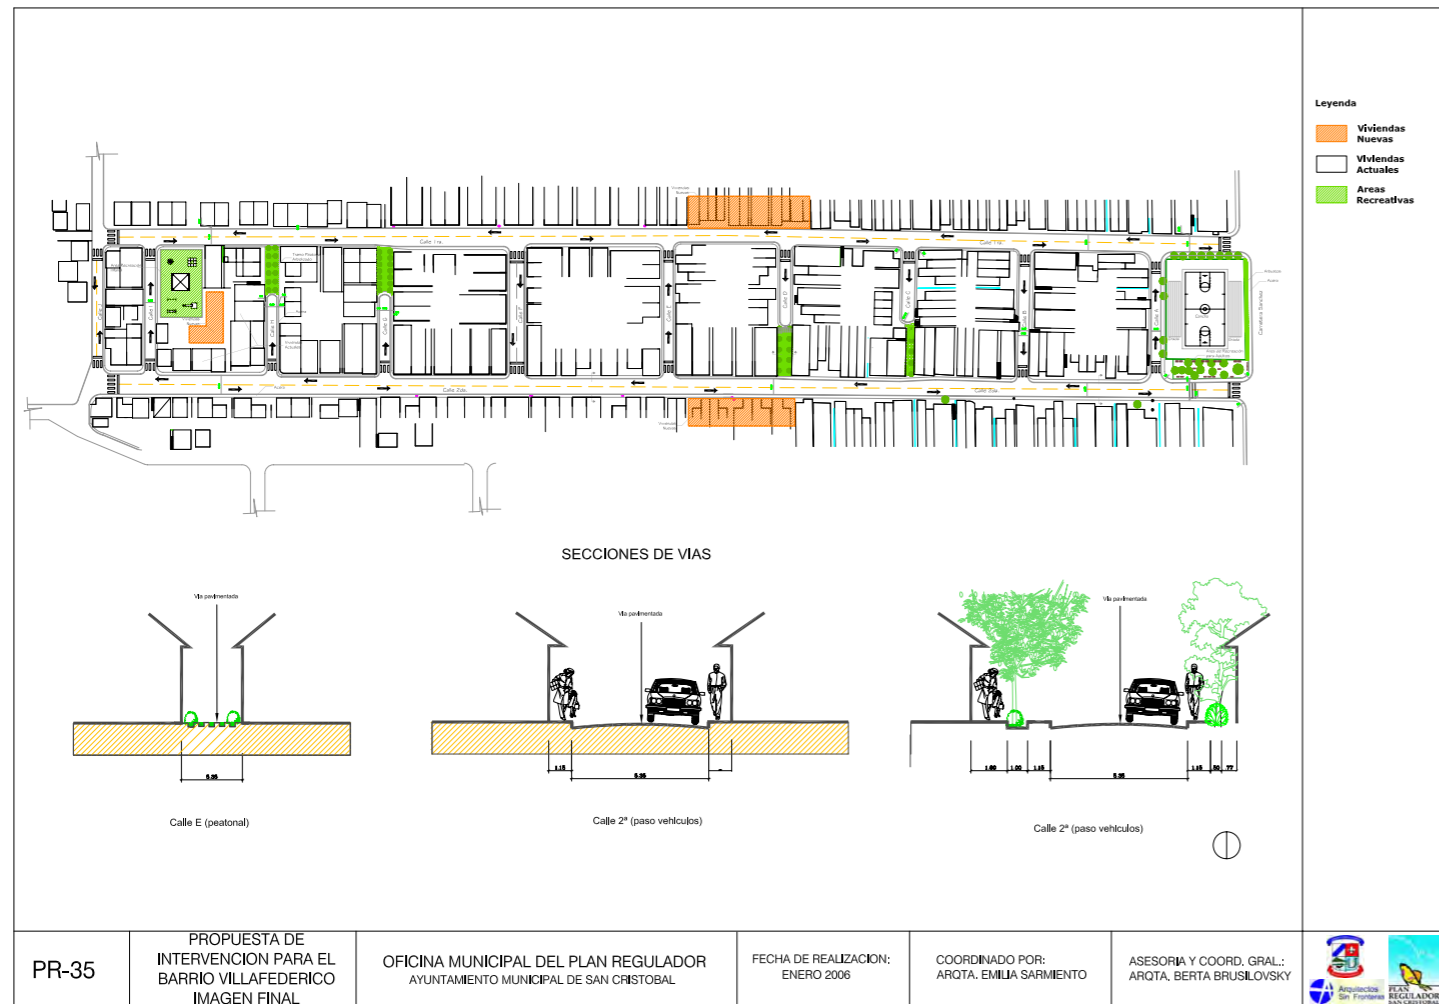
Plano de la propuesta de intervención en el barrio de Villa Federico.
